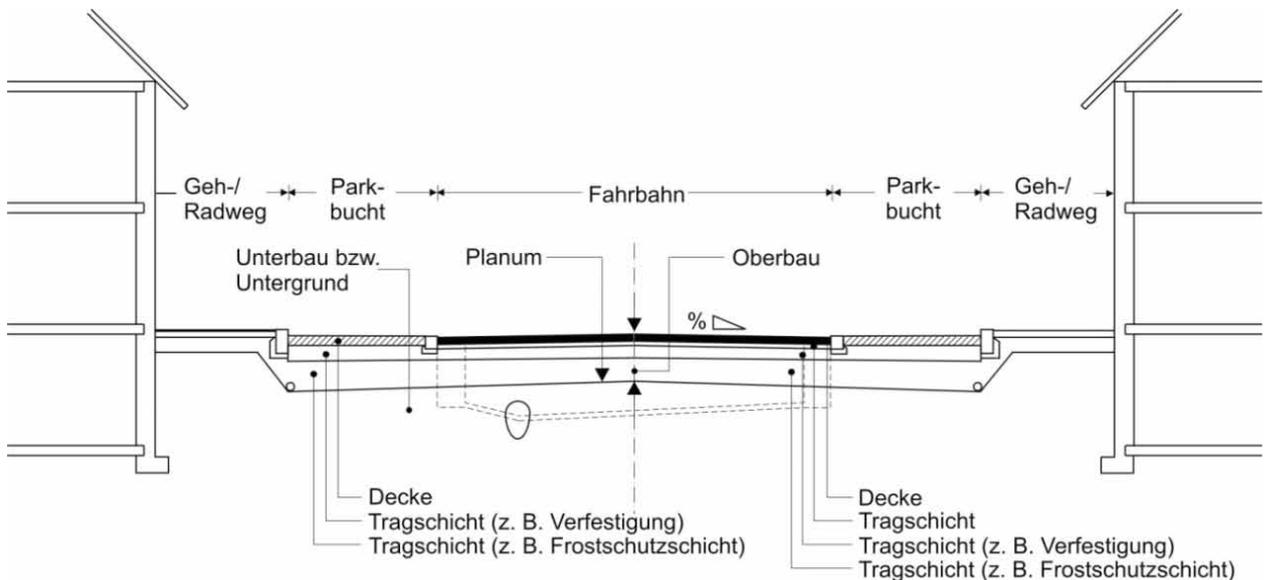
Beispielhafter Aufbau einer Befestigung in geschlossener Ortslage mit wasserundurchlässigen Randbereichen und geschlossener seitlicher Bebauung sowie mit Entwässerungseinrichtungen
